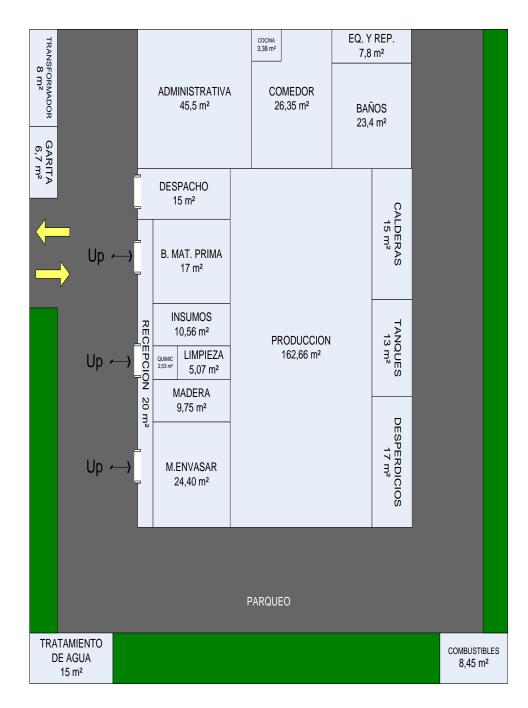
LAYOUT DE LA PLANTA 3
